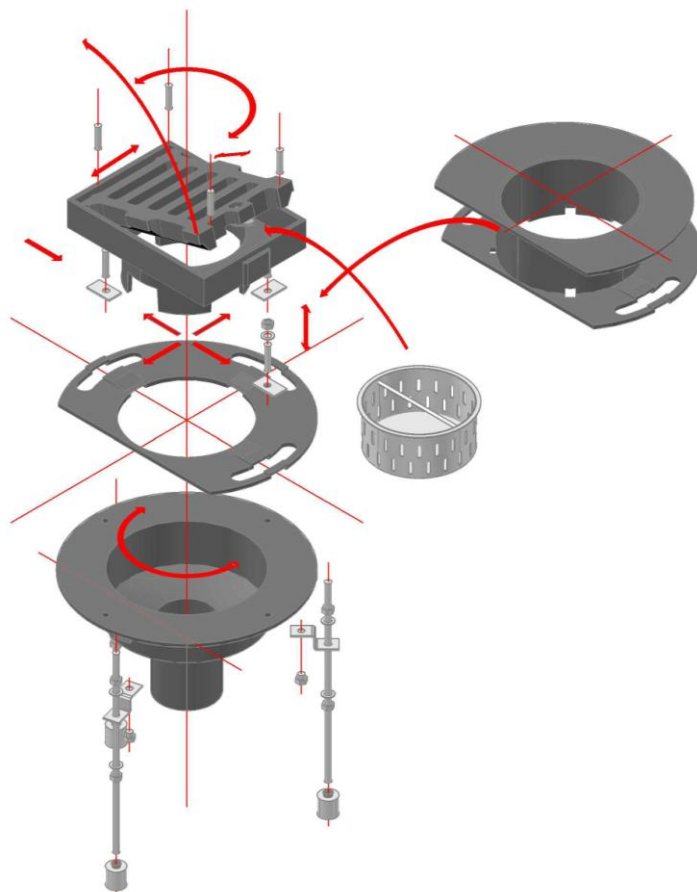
Höllko Brückenablauf – Explosionszeichnung mit Verstellmöglichkeiten [34 S. 4]
